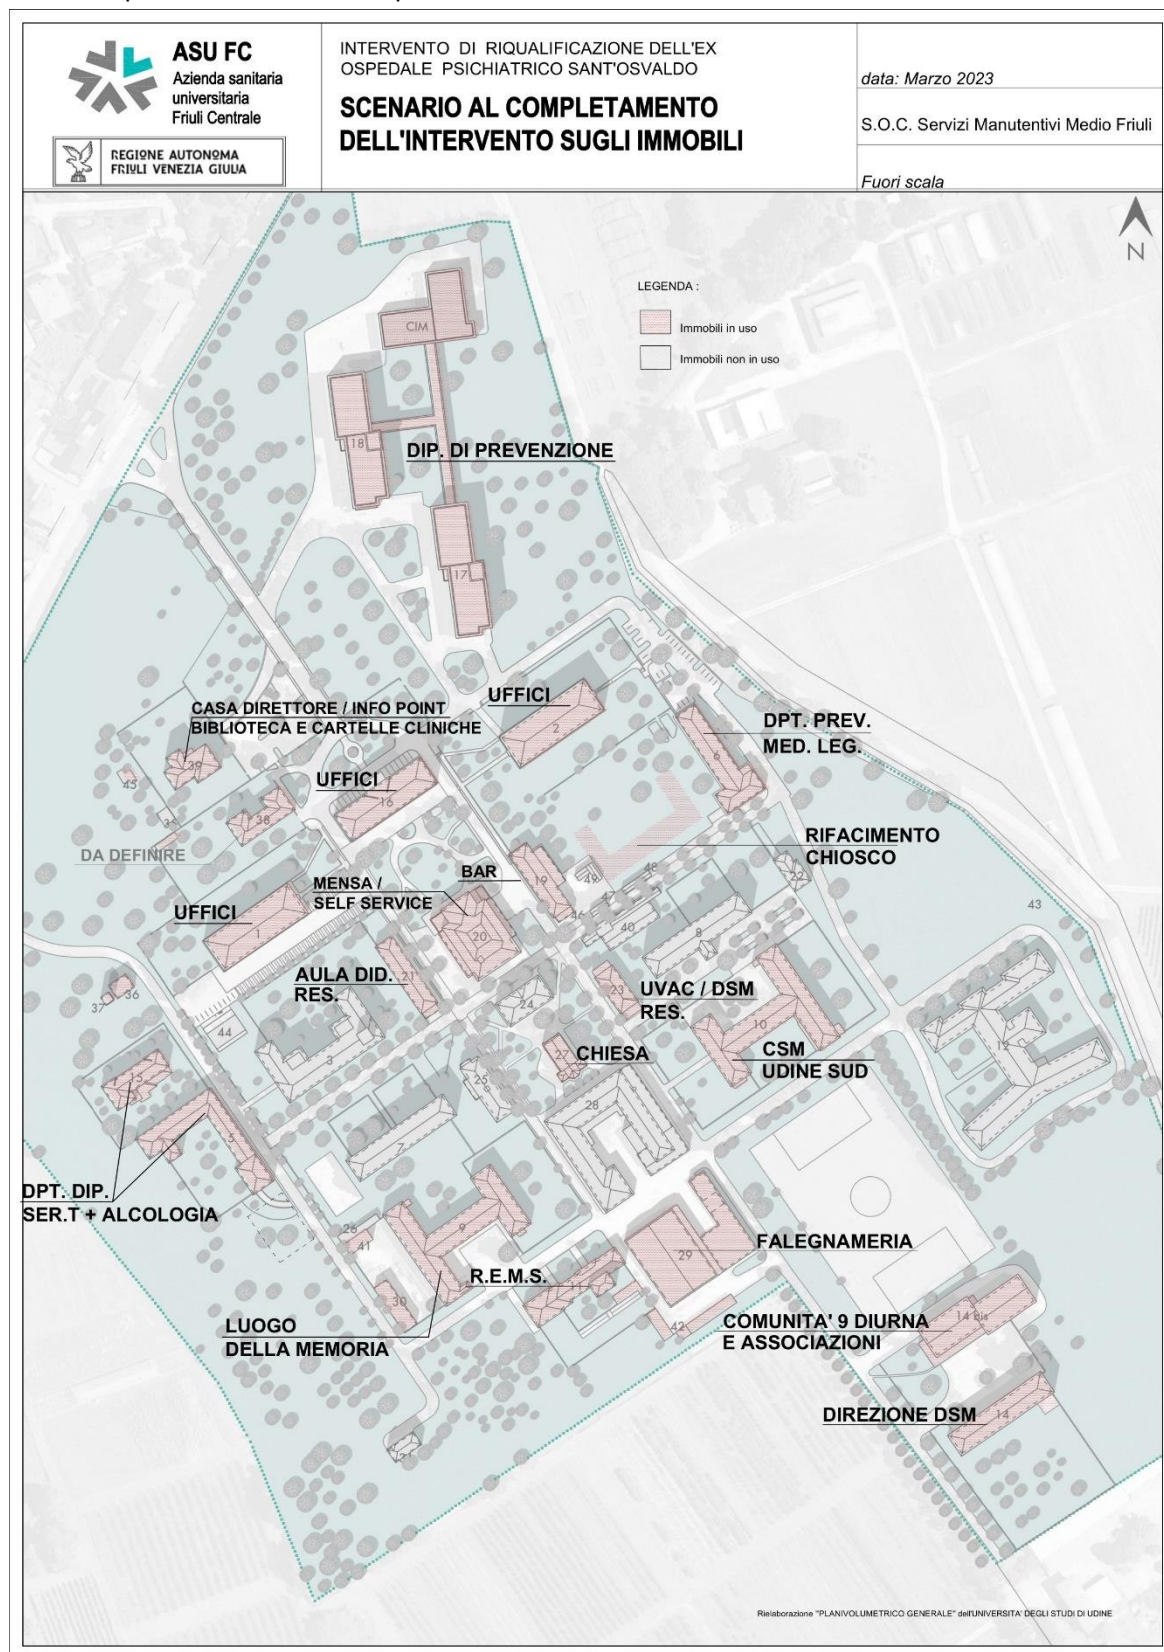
Planimetria dello scenario al completamento dell'intervento sugli immobili
